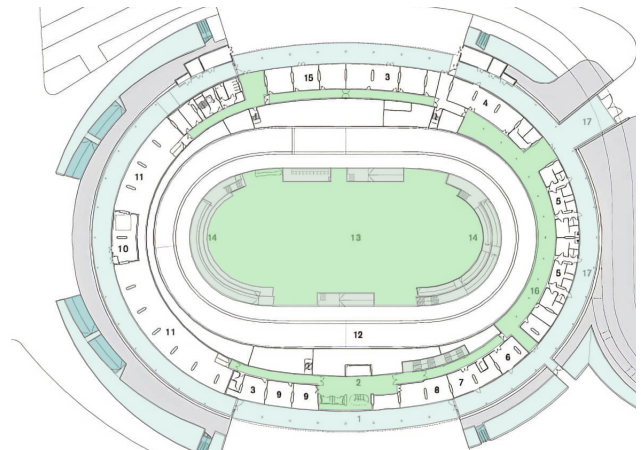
Circulación de la primera planta, Velopark, Londres
